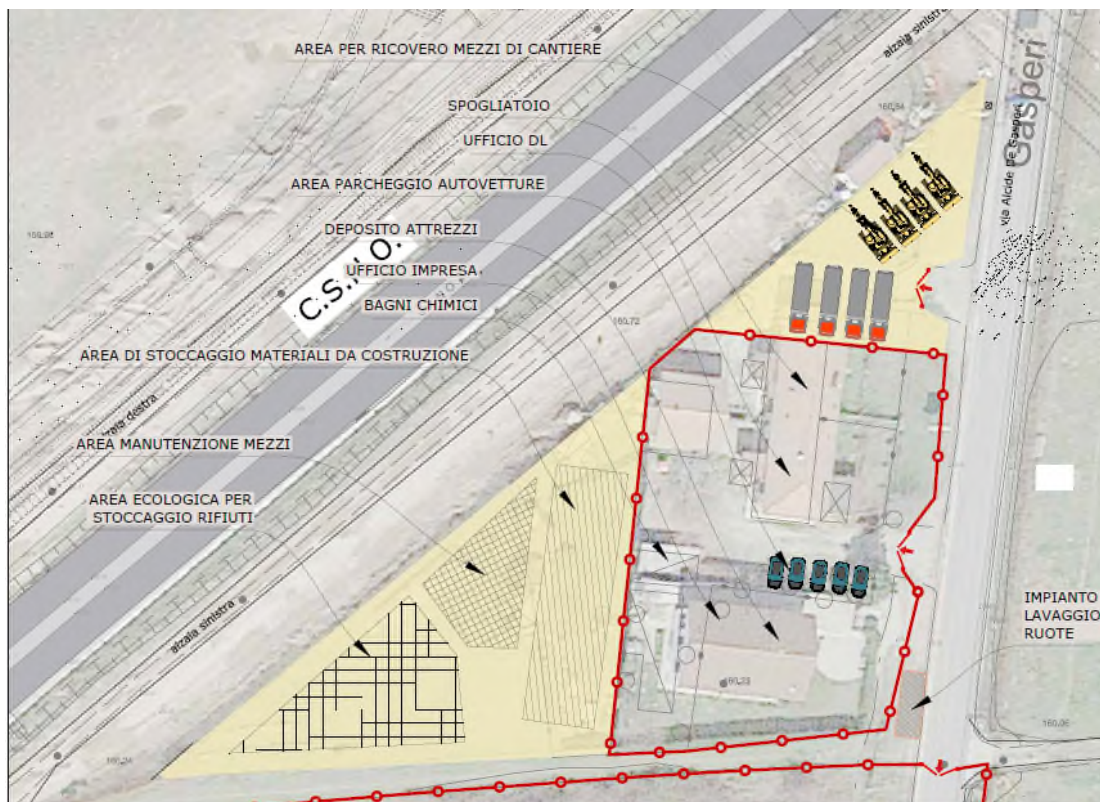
Layout di dettaglio dell'area di accantieramento
